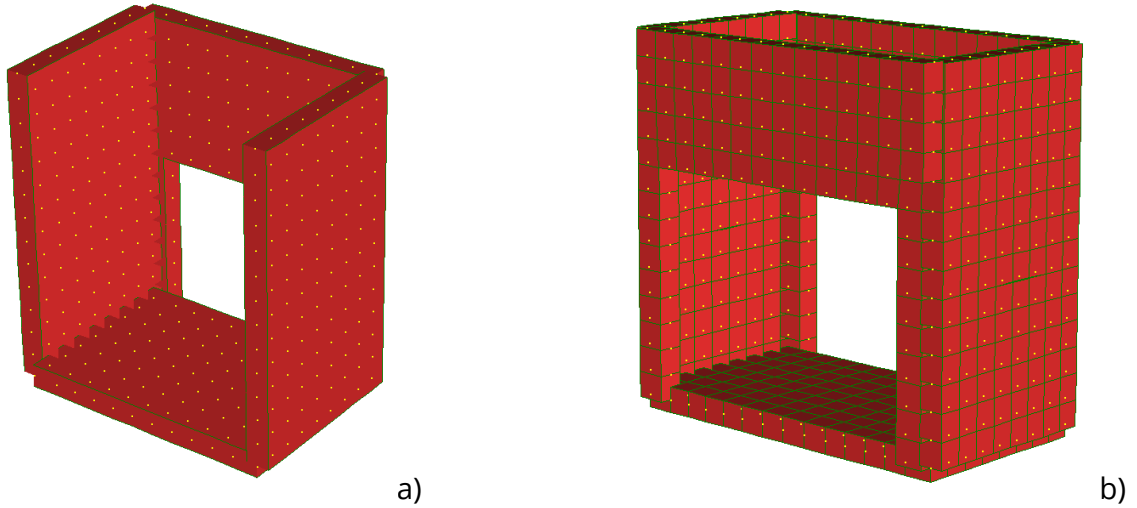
Camera di imbocco a) e pozzetto intermedio b)
